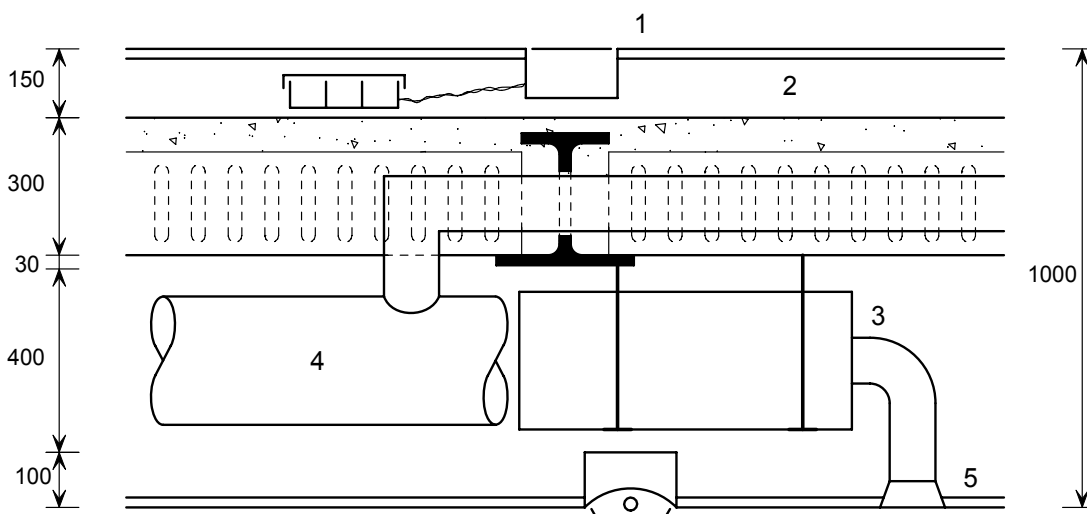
Alternativy umístění rozvodů pod a nad stropní konstrukcí
